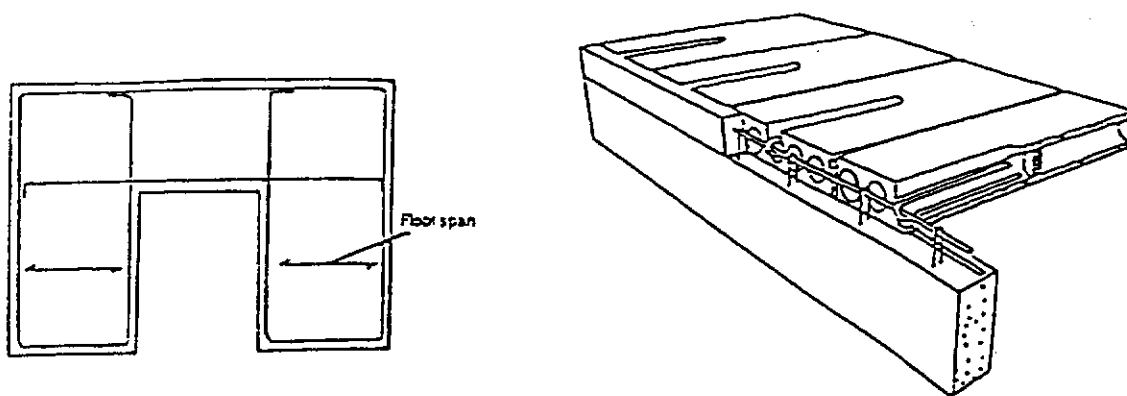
Poutres de ceinture assurant un chaînage du plancher
